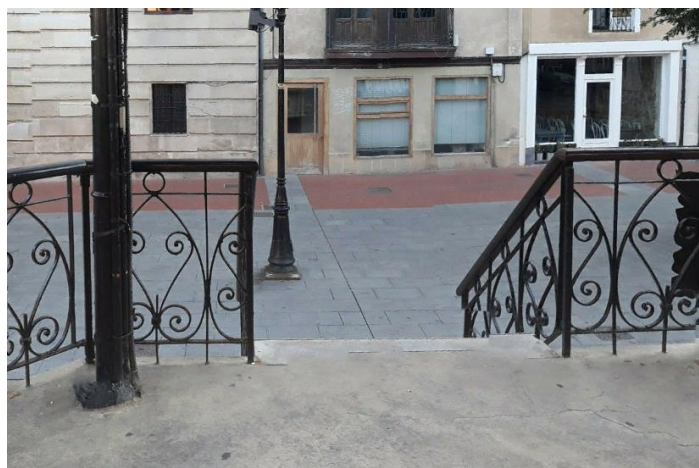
Pavimento en la margen derecha de la Plaza de España
